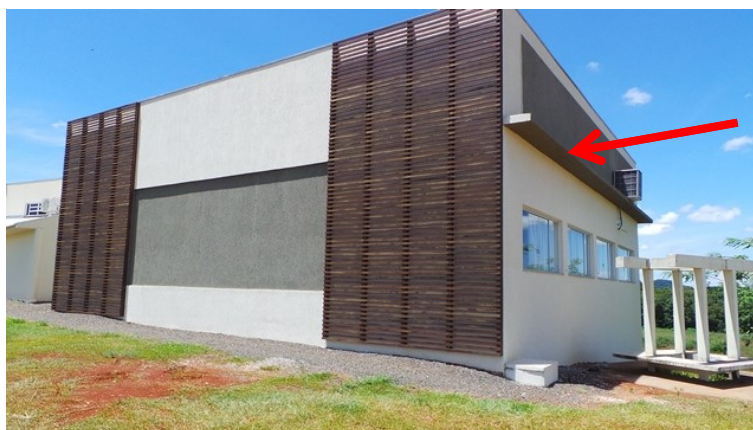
Fotografia – Fachada 1 da biblioteca de Santa Helena
